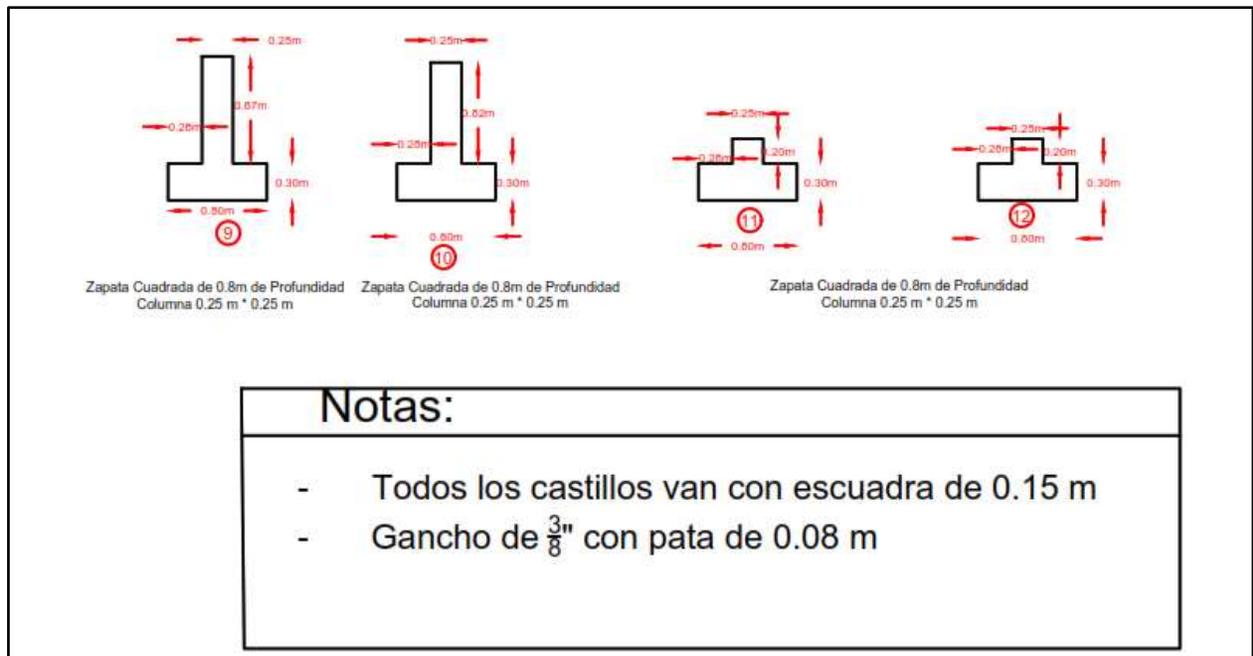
, Medición de Cantidades en Obra, Fuente: Elaboración Propia
